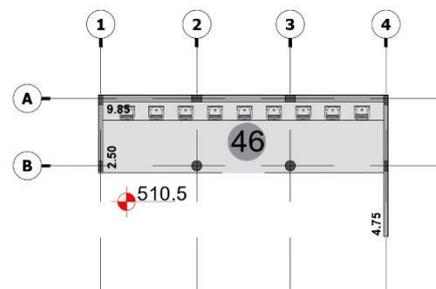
Planta - Estacionamento carroceiros e espaço pet
